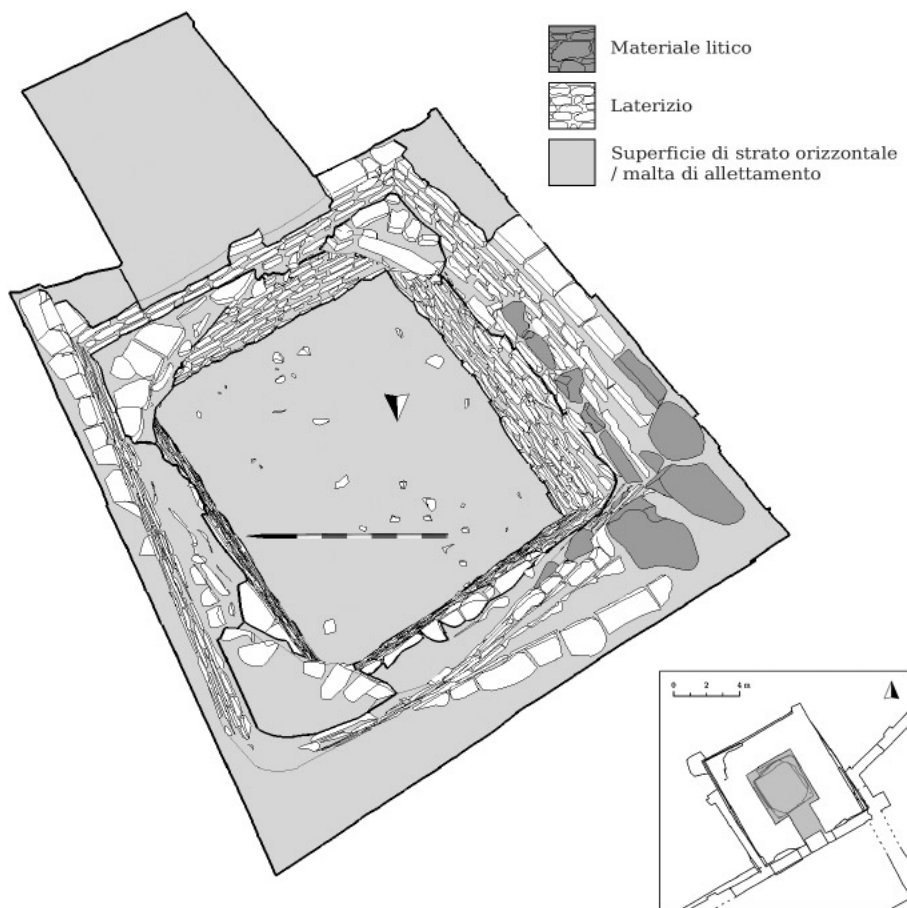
Campanile di San Severo (Ravenna, RA). Restituzione tridimensionale della stratigrafia muraria e degli elementi strutturali, con individuazione dei diversi materiali costruttivi (vista prospettica).
